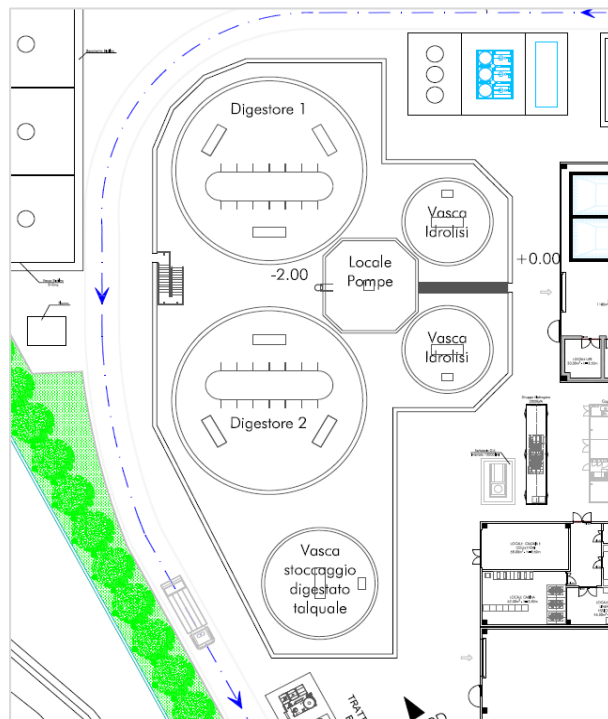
Area vasche e digestori_ Stralcio dalla planimetria generale
